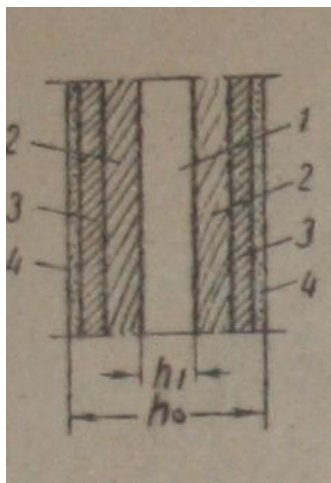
Подвійна стіна із шлакобетонних плит з повітряним прошарком.
